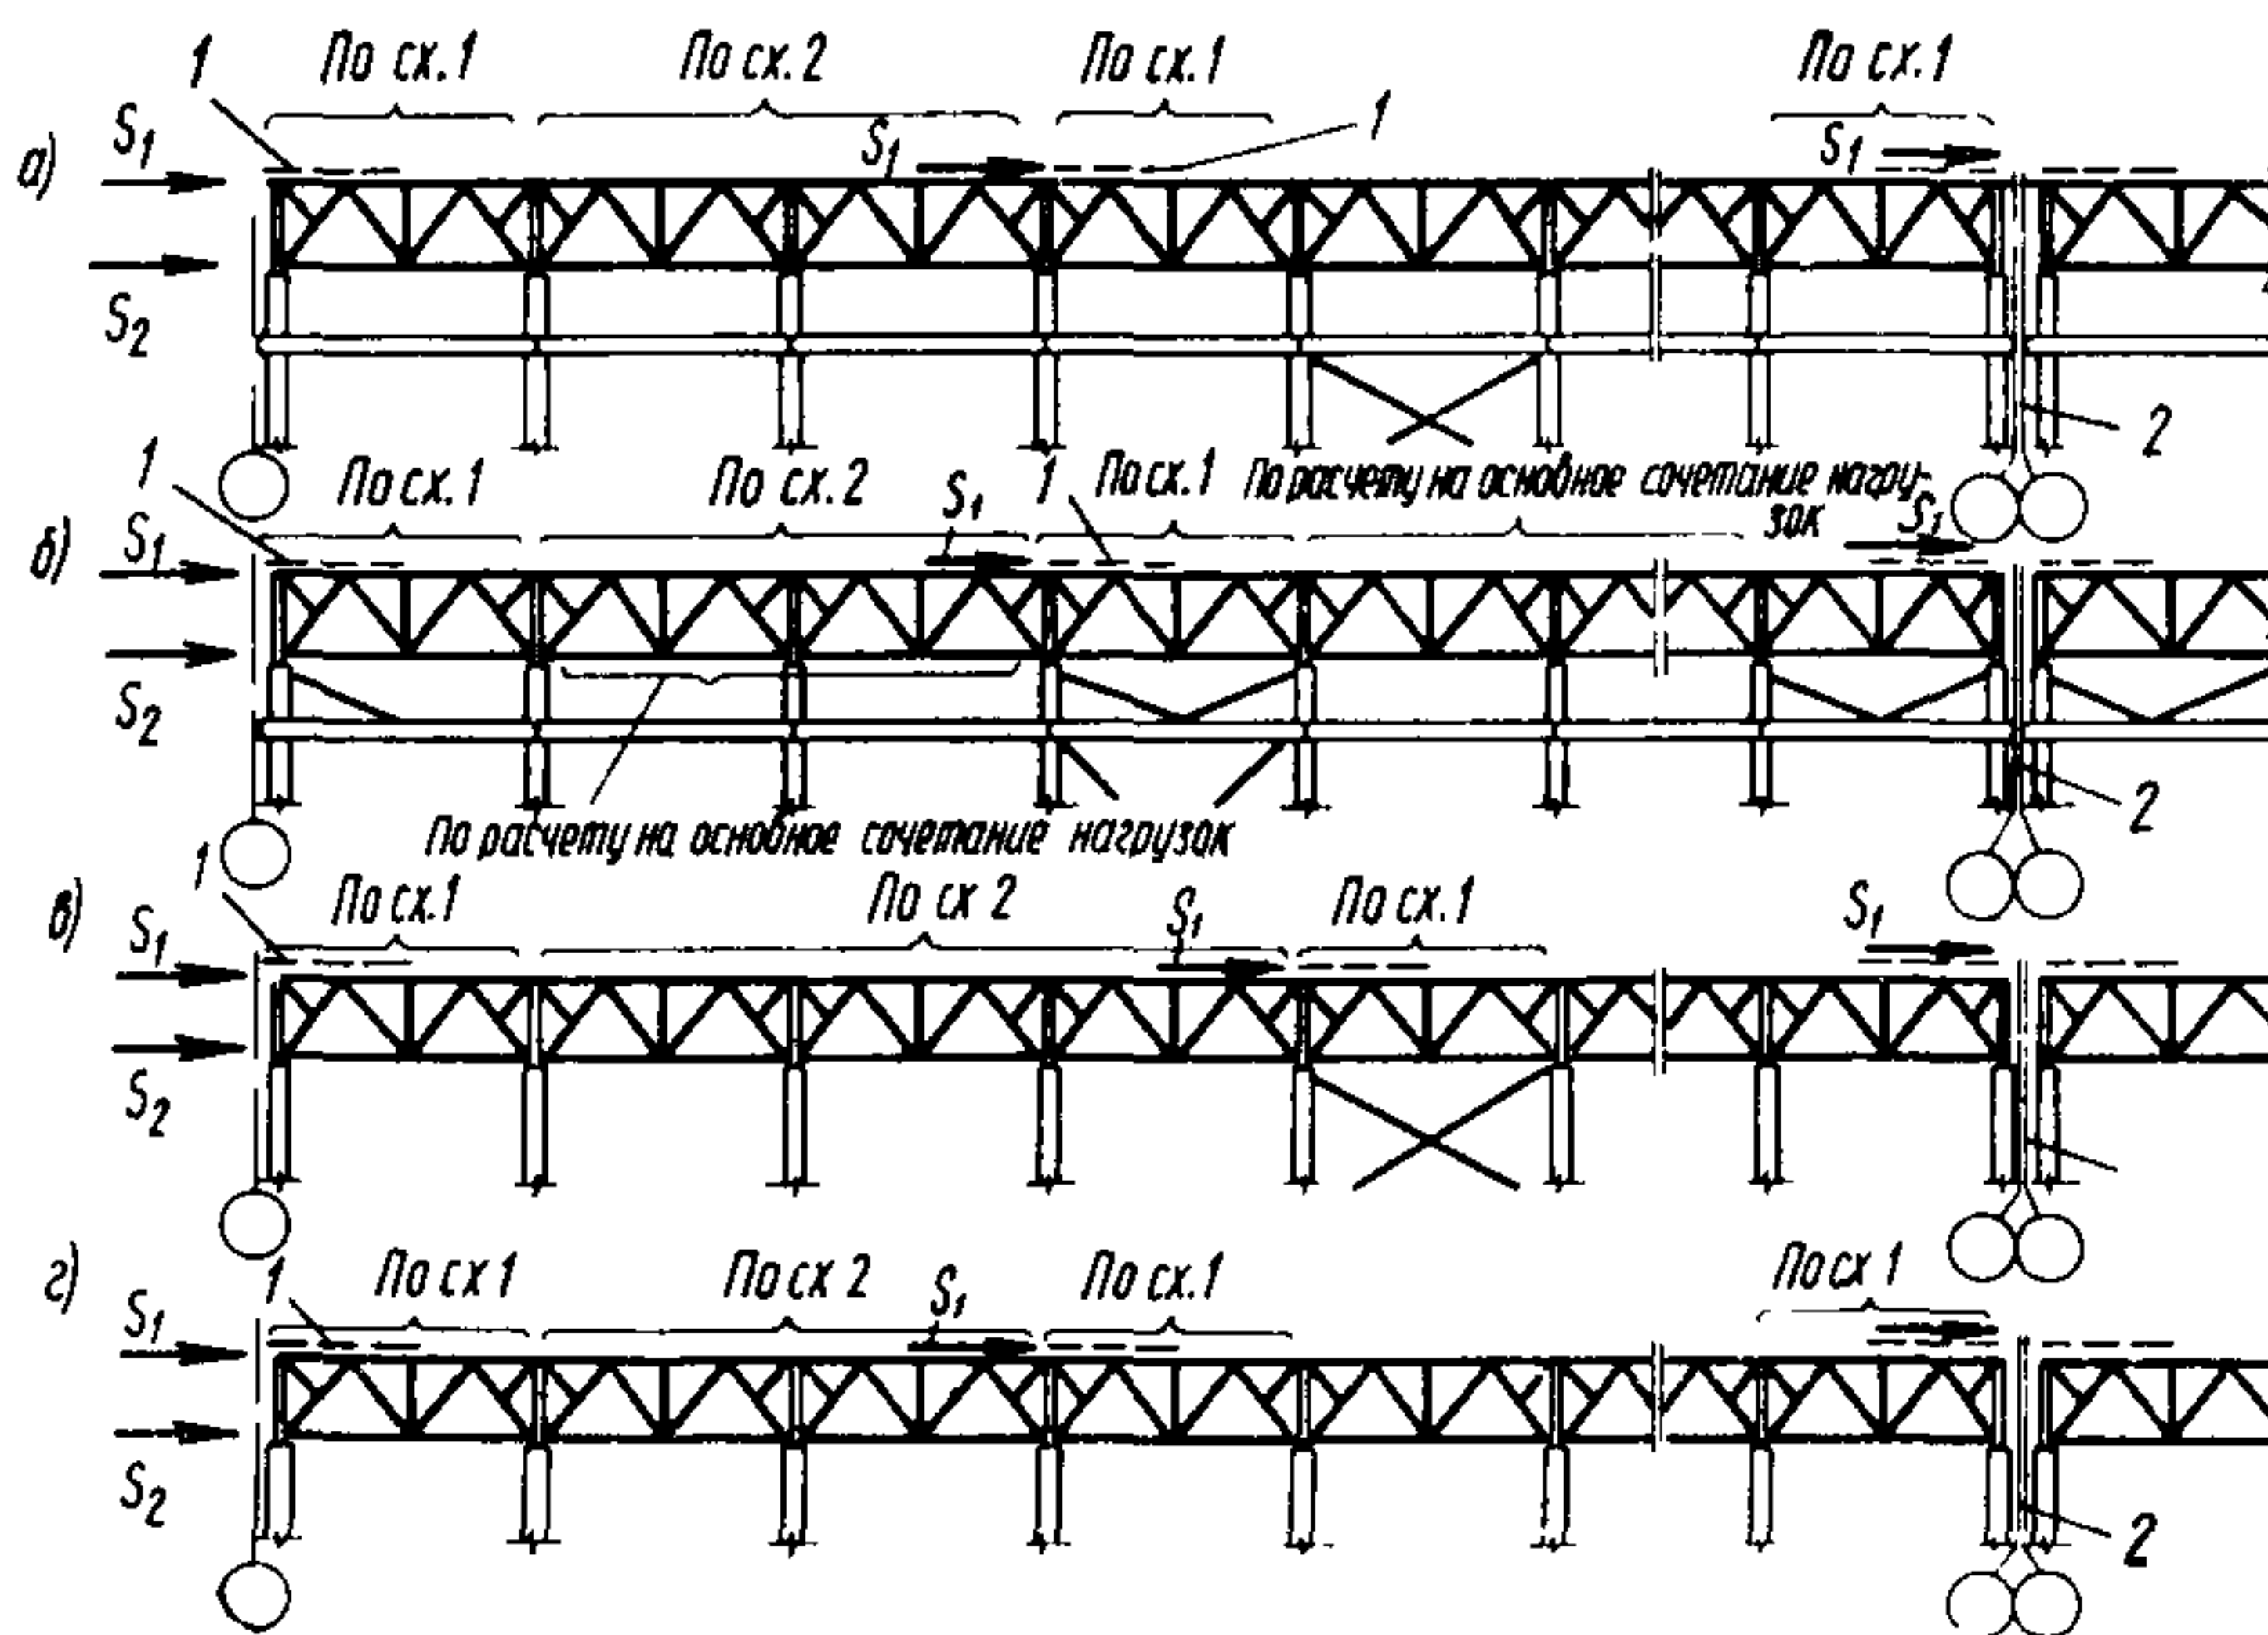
Расположение расчетных схем подстропильных ферм по длине зданий (отсеков) с покрытиями из стального профилированного настила
